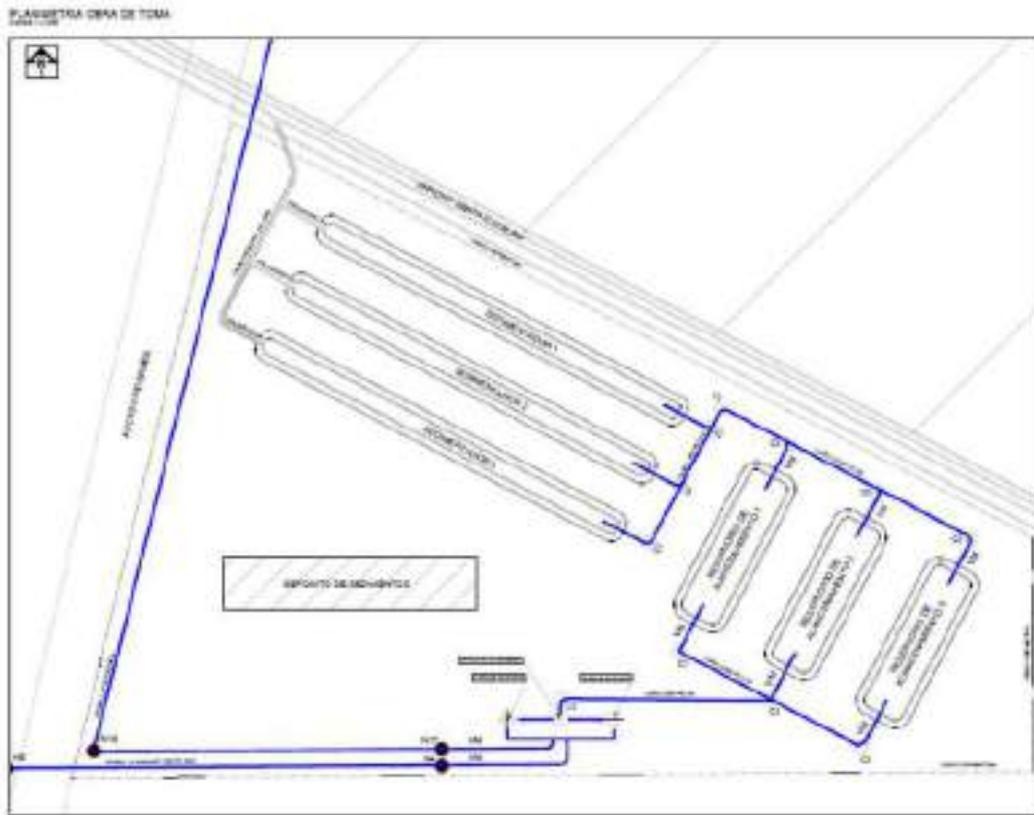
Planimetría de la obra de toma en el acceso a Riobamba
